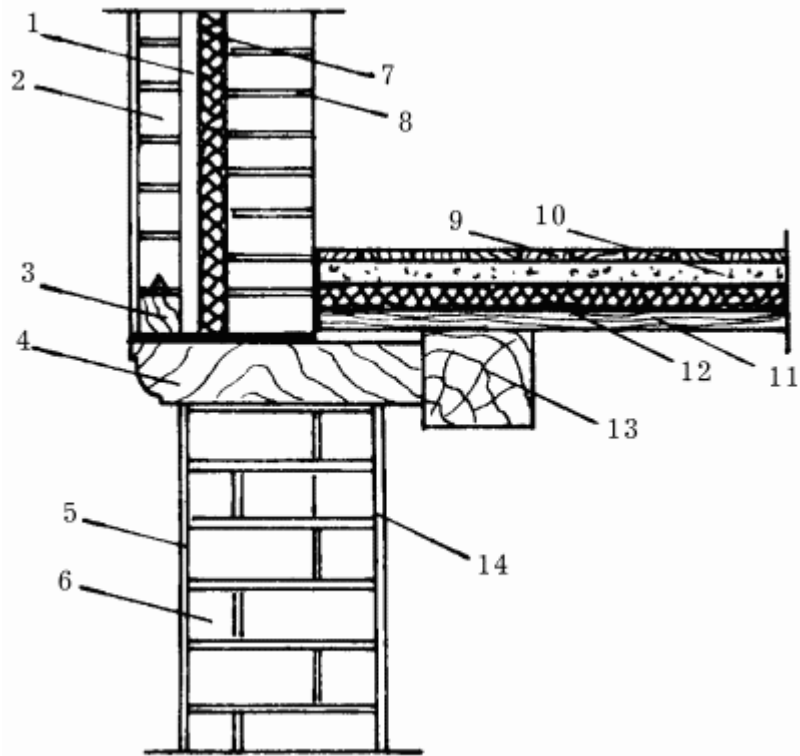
Устройство пола в чердачной квартире: 1 – воздушное пространство; 2 – кирпичная кладка; 3 – брус обвязки; 4 – фахверк из дуба; 5 – штукатурка; 6 – кладка; 7 – теплоизоляция; 8 – кладка; 9 – дубовый паркет; 10 – стяжка; 11 – дубовый брус (старый); 12 – звукоизоляция; 13 – дубовая балка (старая); 14 – внутренняя штукатурка.
